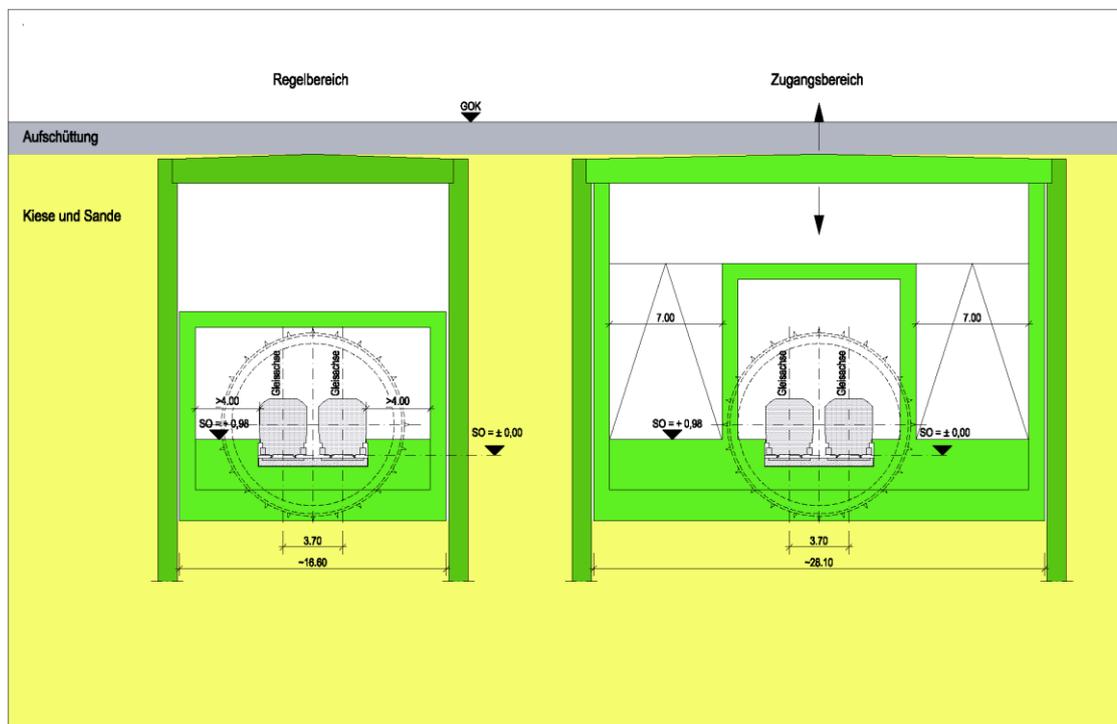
Systemdarstellung Variante 1: offene Bauweise/ Deckelbauweise
